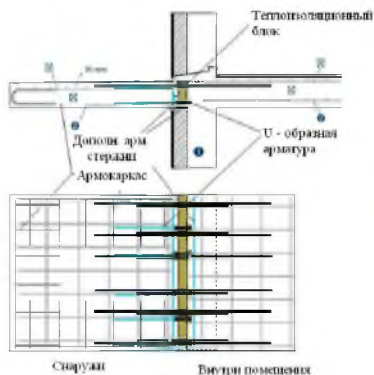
Несущий теплоизоляционный блок в случае сопряжения «балкон – наружная стена – плита перекрытия»
